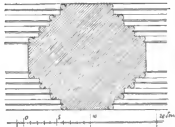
Profilierung des Pfeilers in der Kirche zu Mühlhausen.
